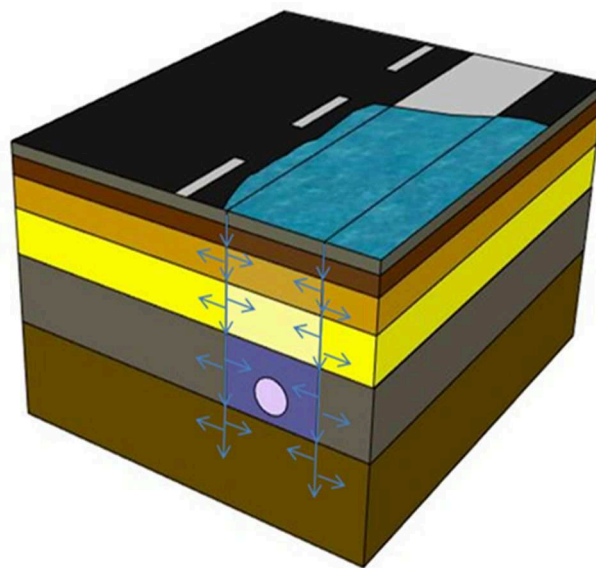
Infiltration d'eau dans la chaussée à travers les joints de la tranchée
